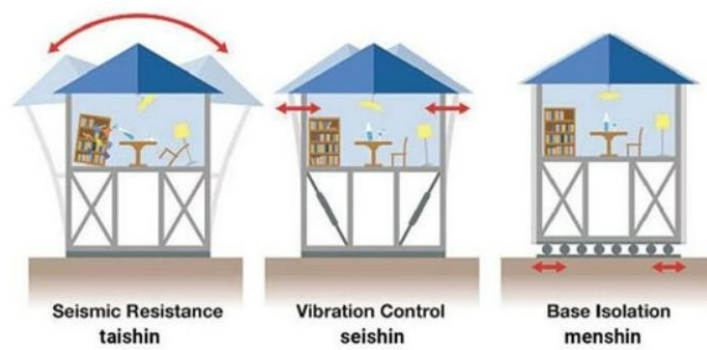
Pondasi Bangunan tahan gempa di Jepang
